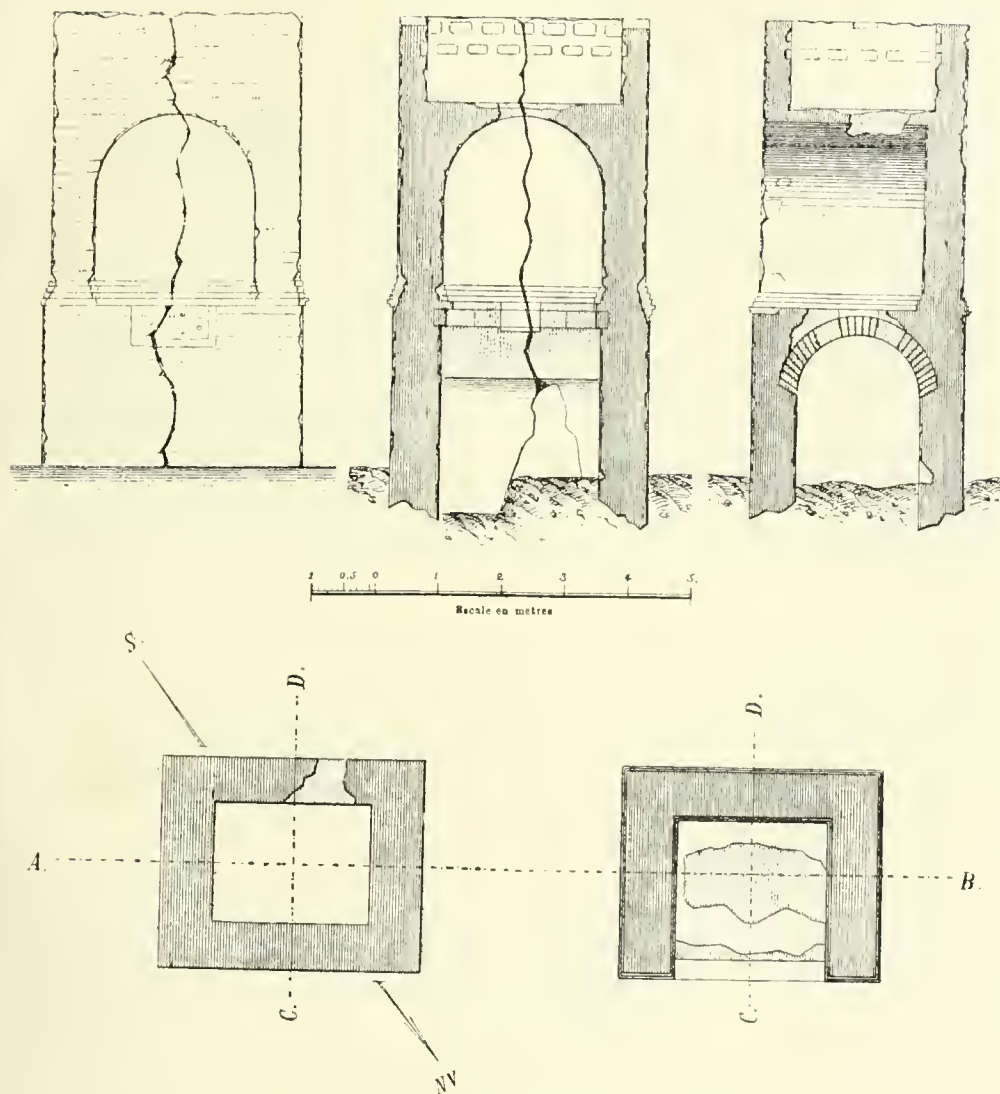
Sepulchre de Vilablareix. — Plans, façades y secciones (Girbal)
